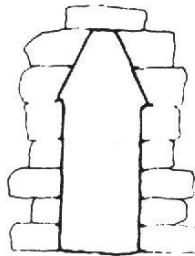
Arco de zapatas o falso Arquitectura Maya
